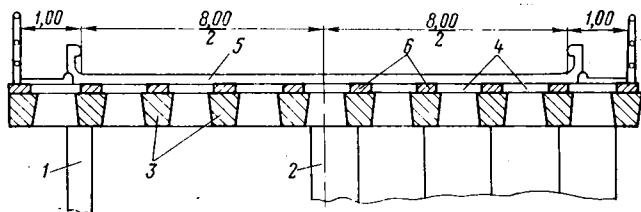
Поперечный разрез моста (слева — для путепроводов, справа — для мостов на реках с ледоходом): 1 — стойки; 2 — сплошная стенка; 3 — балки; 4 — сборные плиты; 5 — покрытие; 6 — бетон омоноличивания плит с балками
